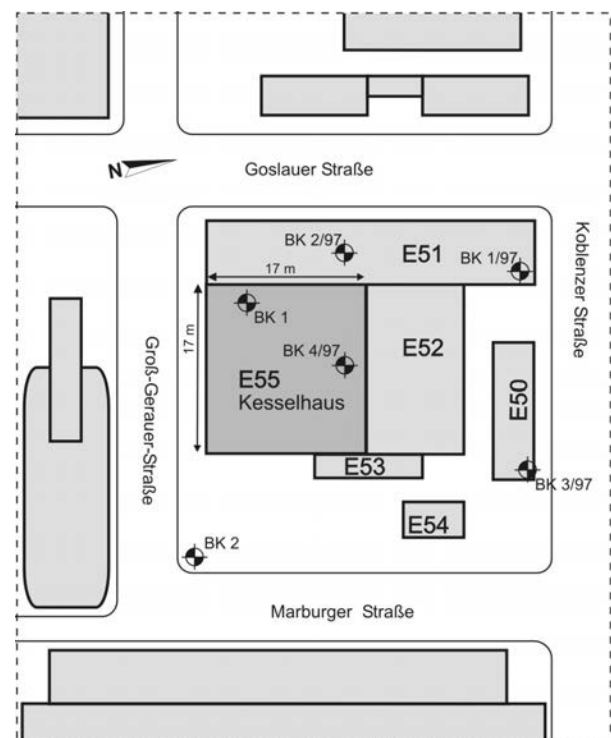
Lageplan des Projektes im Norden Darmstadts, Lage der Kernbohrungen
